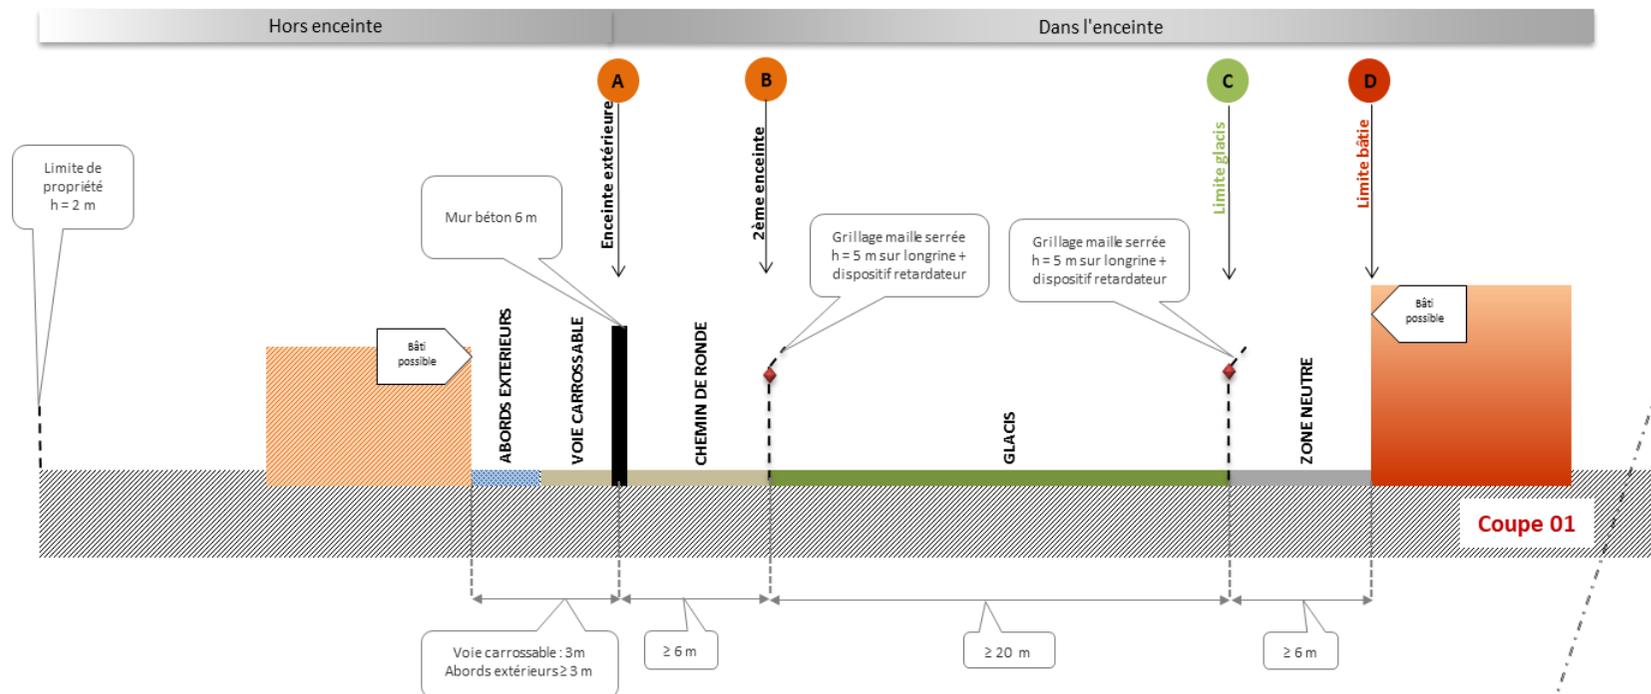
Coupe 1 - Enceinte délimitée par un mur béton de 6 m de haut (Source : APIJ)
